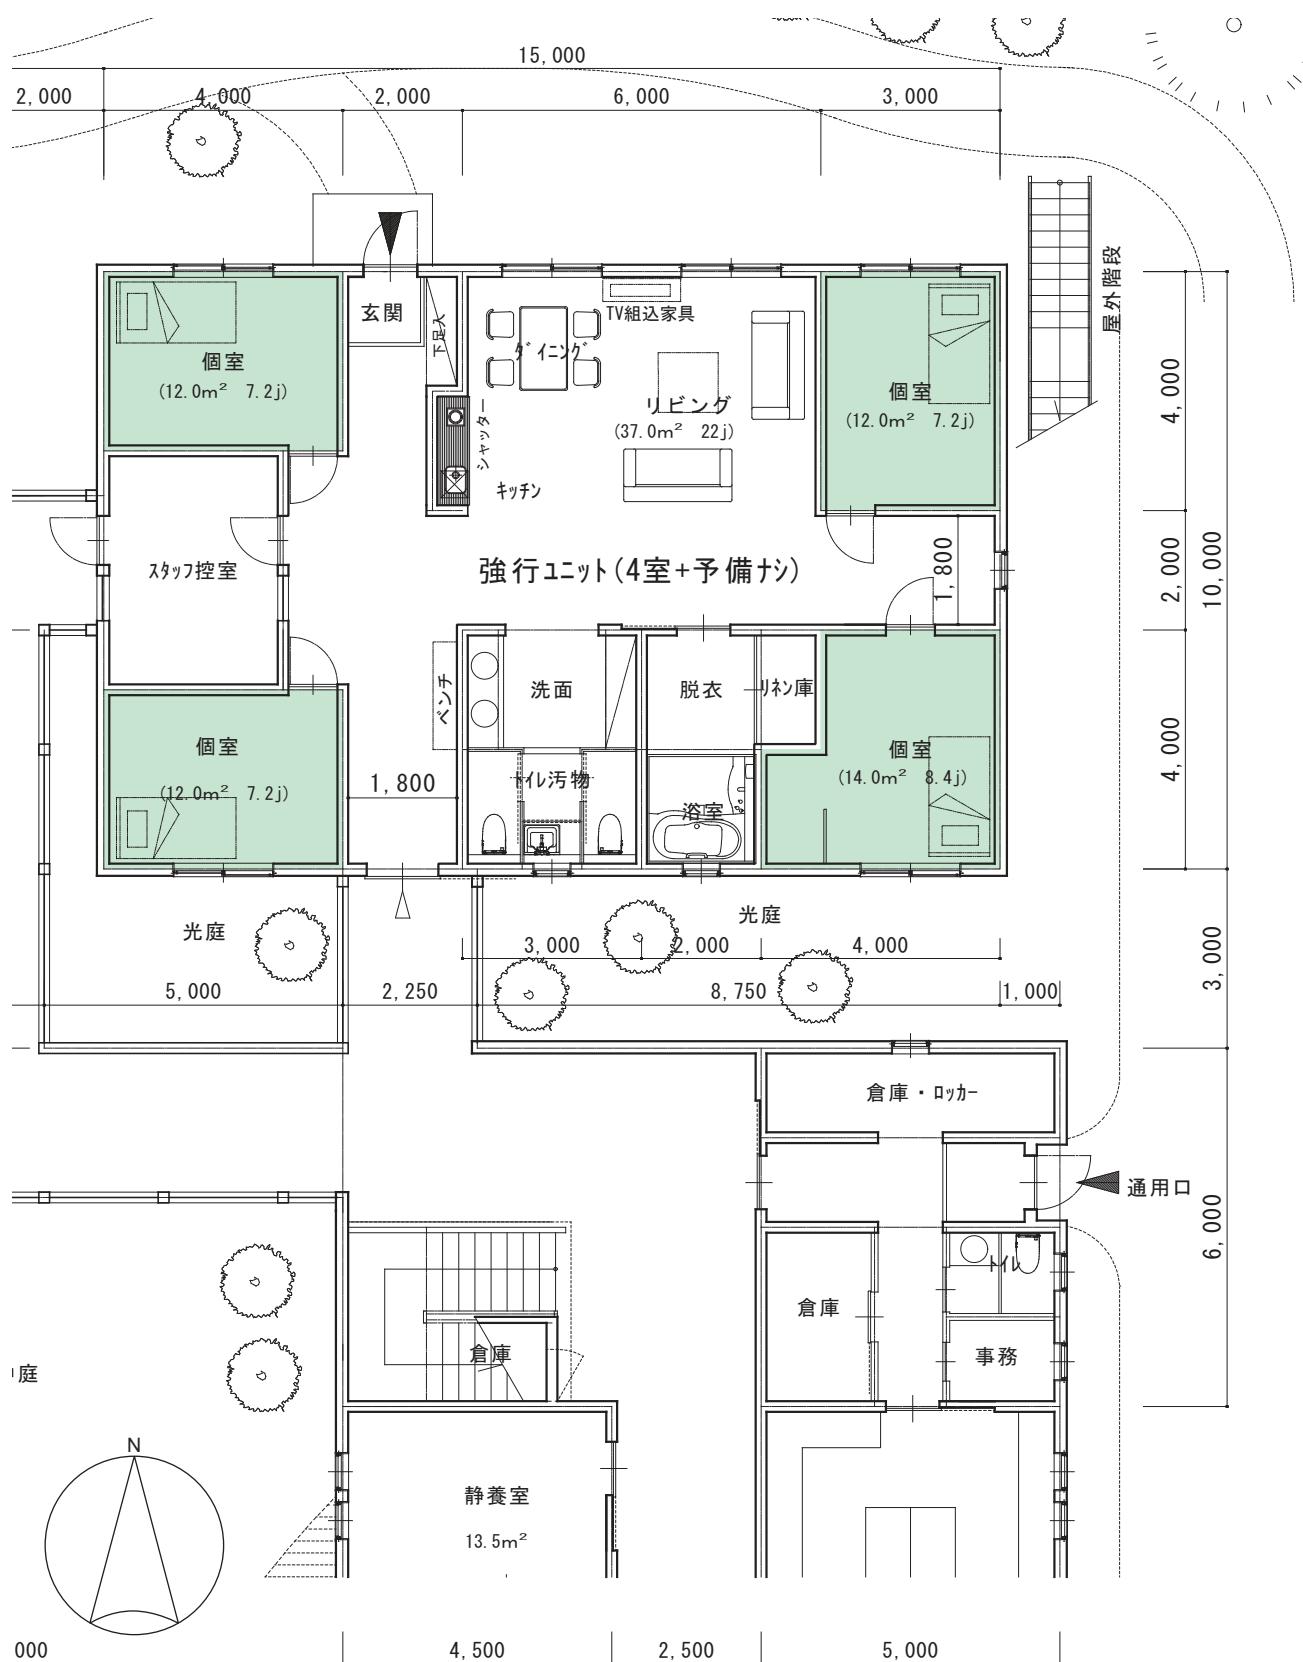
都市型生活施設の強度行動障害ユニット（1階平面図）
